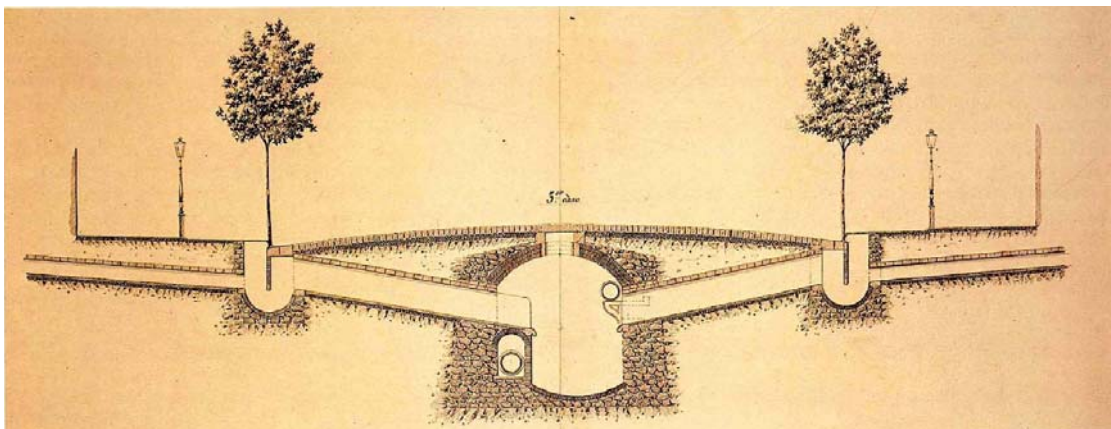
> "Perfiles del pavimento y obras subterráneas de las calles en el supuesto de que la exportación de las aguas se haga por las calles principales" 3º caso (Cerdà 1859, lámina XXXVI)
